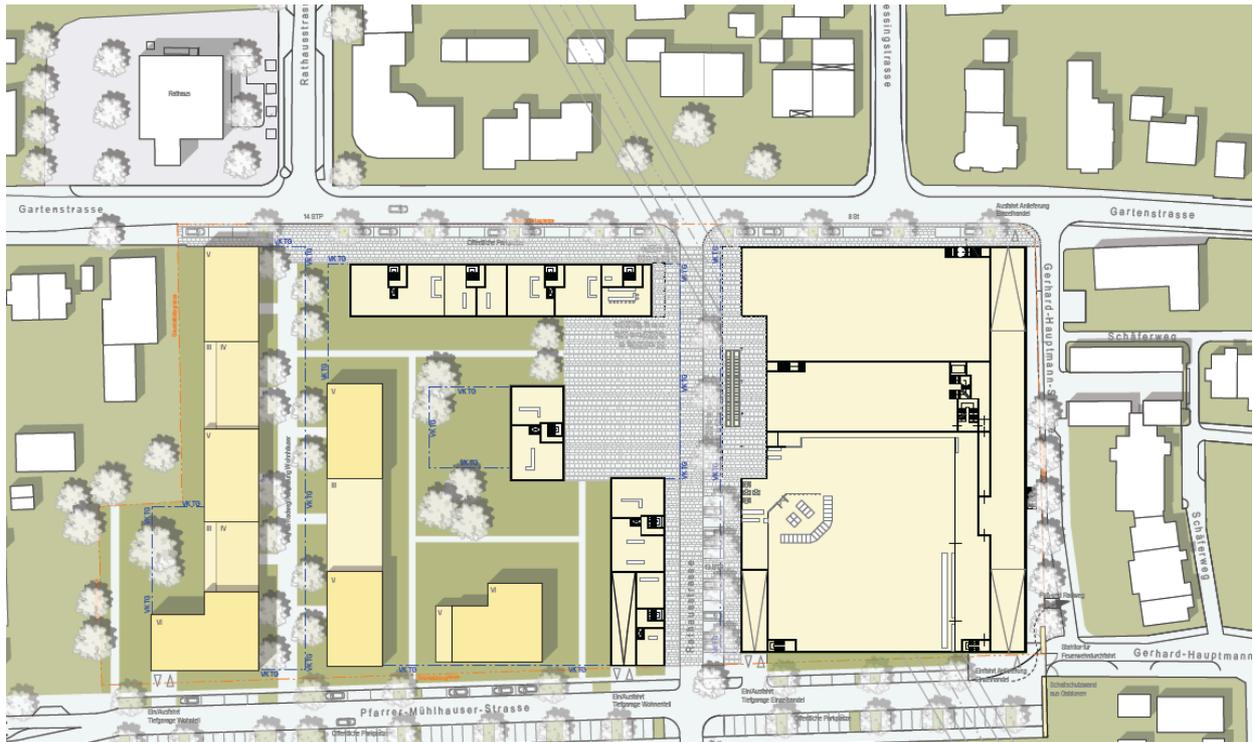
Erdgeschossgrundriss- und Freiflächenplan mit Platzfläche und Arkaden (ohne Maßstab)
